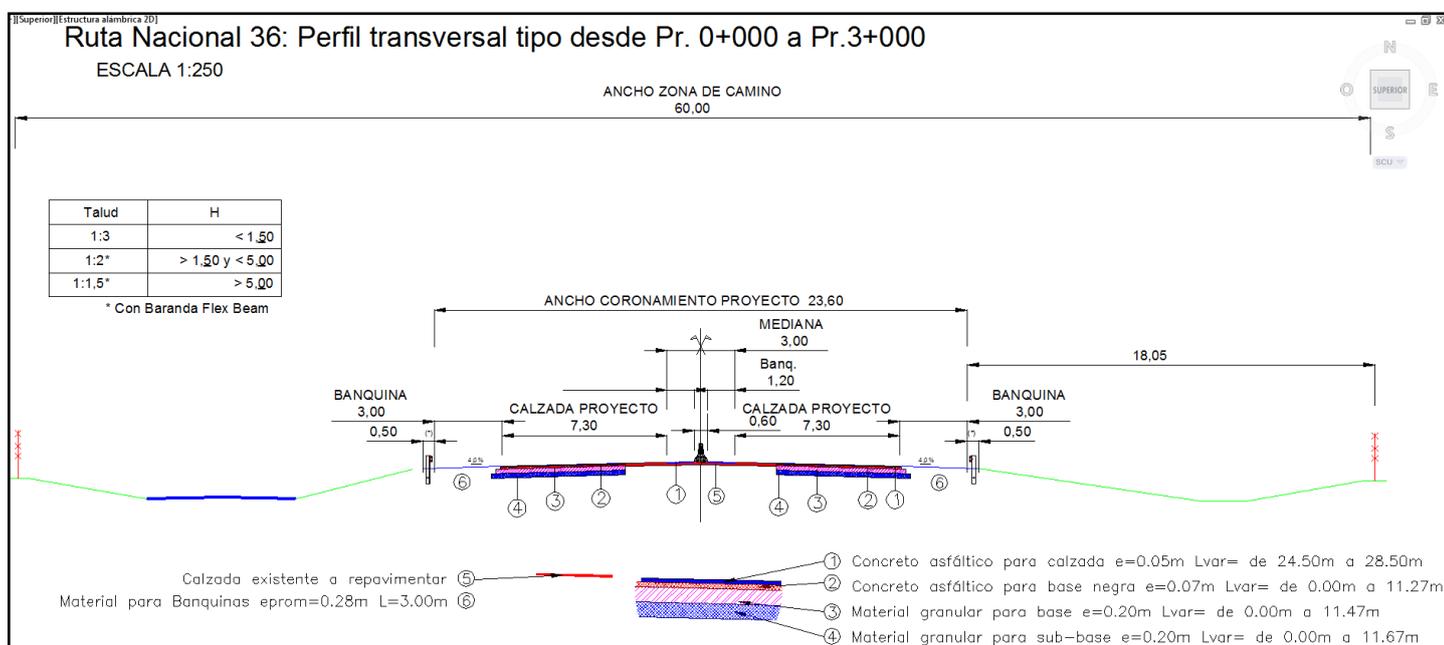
Perfil Tipo N°1 - Autovía con New Jersey
